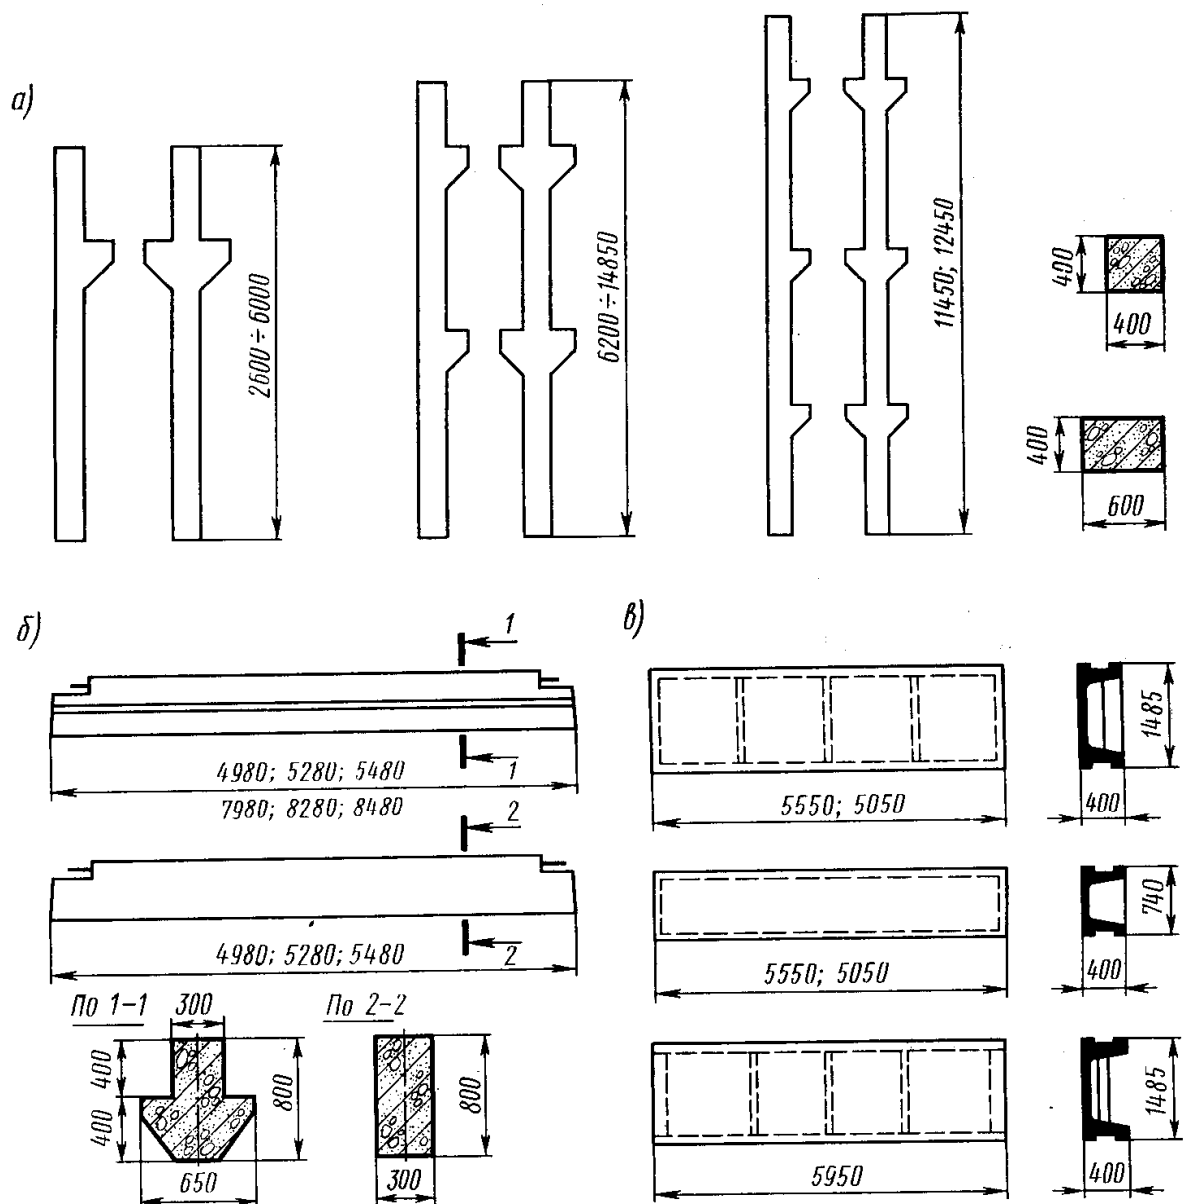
Схема елементів балочного залізобетонного каркаса:
